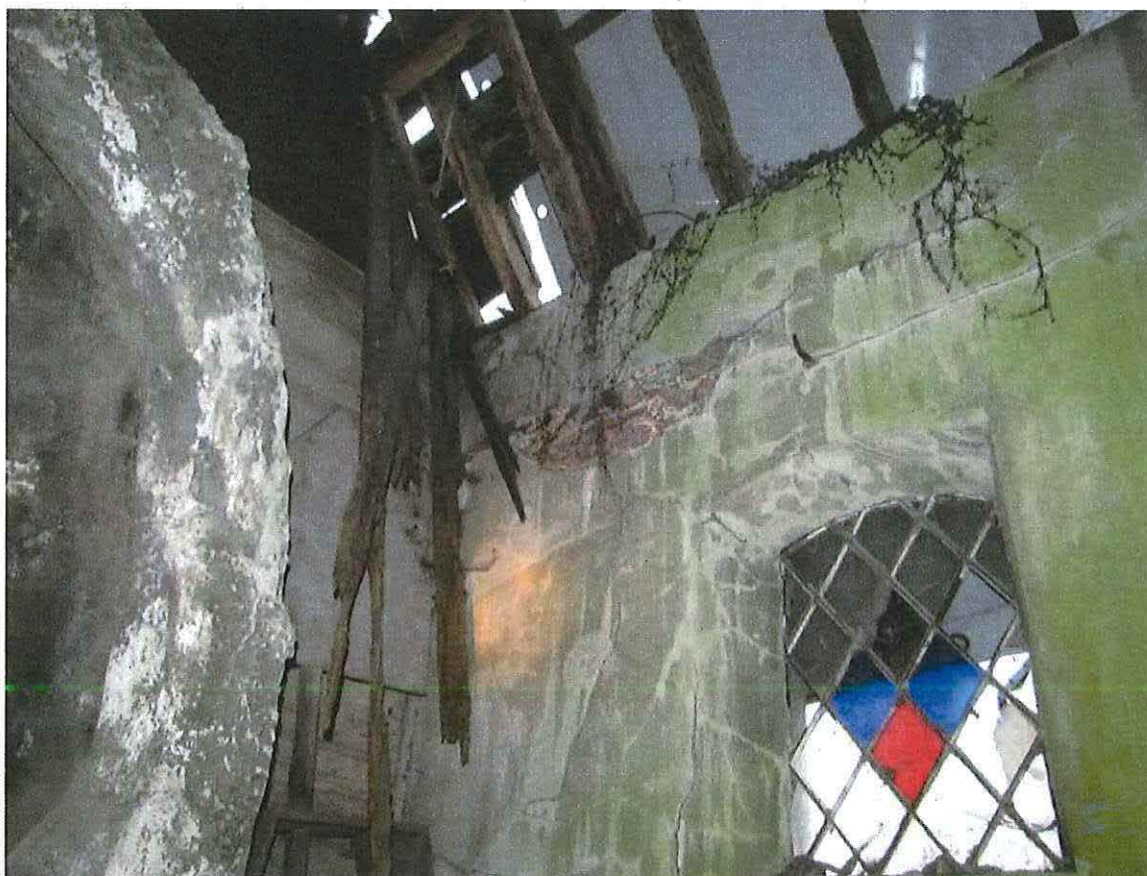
Detail noordwestelijke zijmuur met glas-in-loodraam (© Triconsult 07/02/2017).
